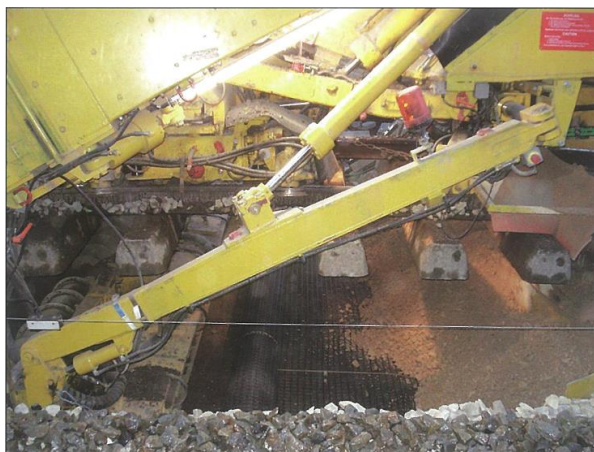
Reforço da superestrutura com geogrelha (Plasser American Website, 2018)
